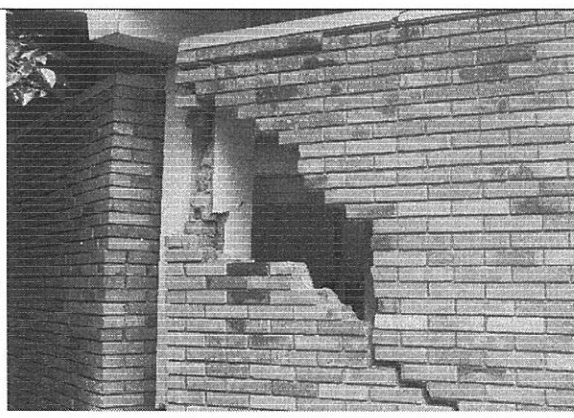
Colapso parcial de muros perimetrales, costado oriental
